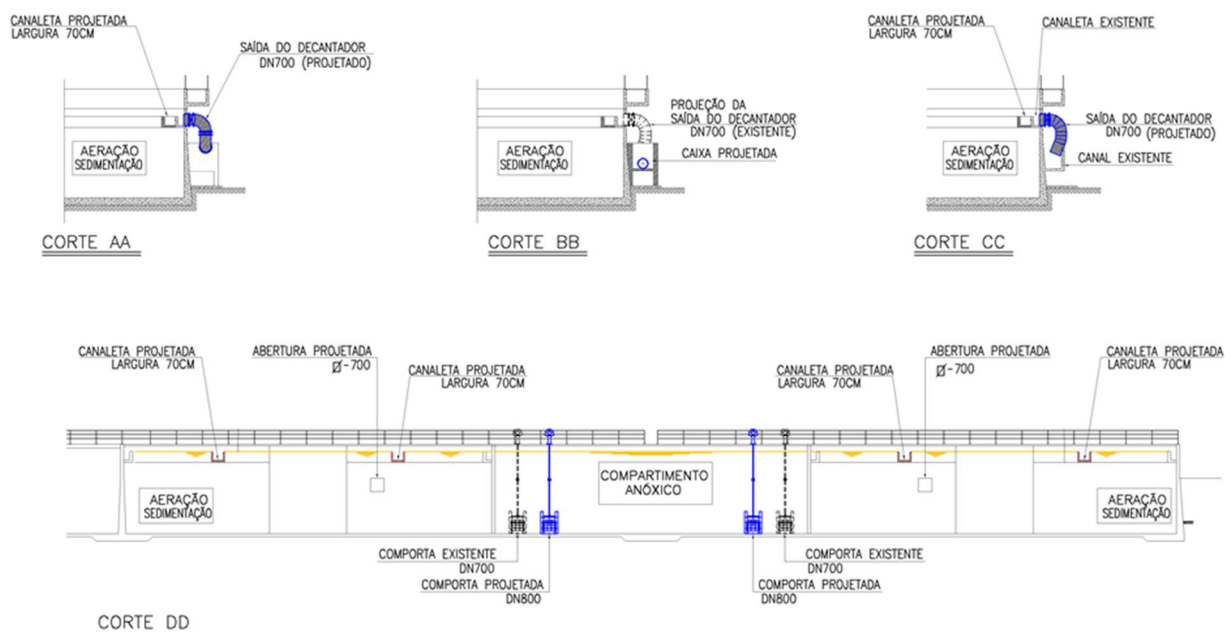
ĩ Proposição de melhorias hidráulicas na ETE Araças - Cortes
